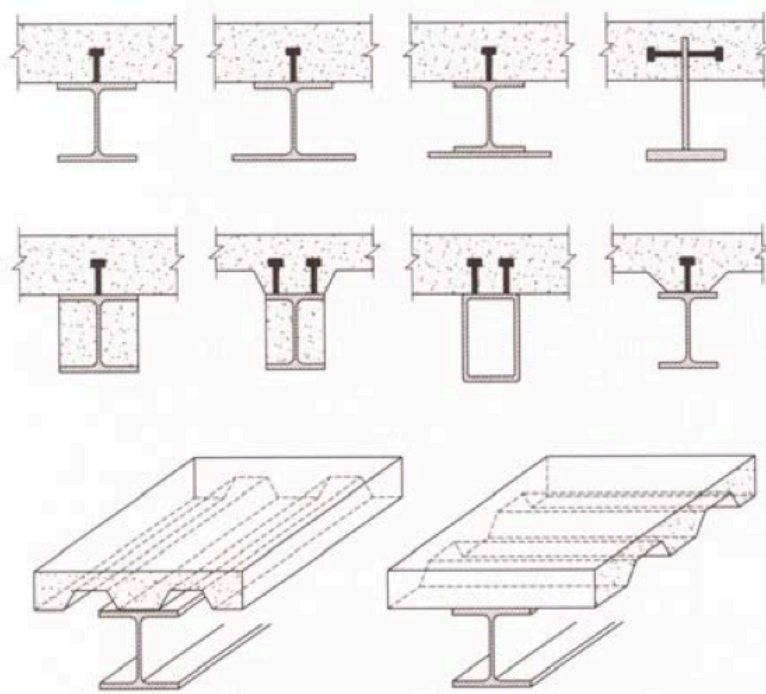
Pormenor da ligação entre as vigas metálicas e o tabuleiro de betão
